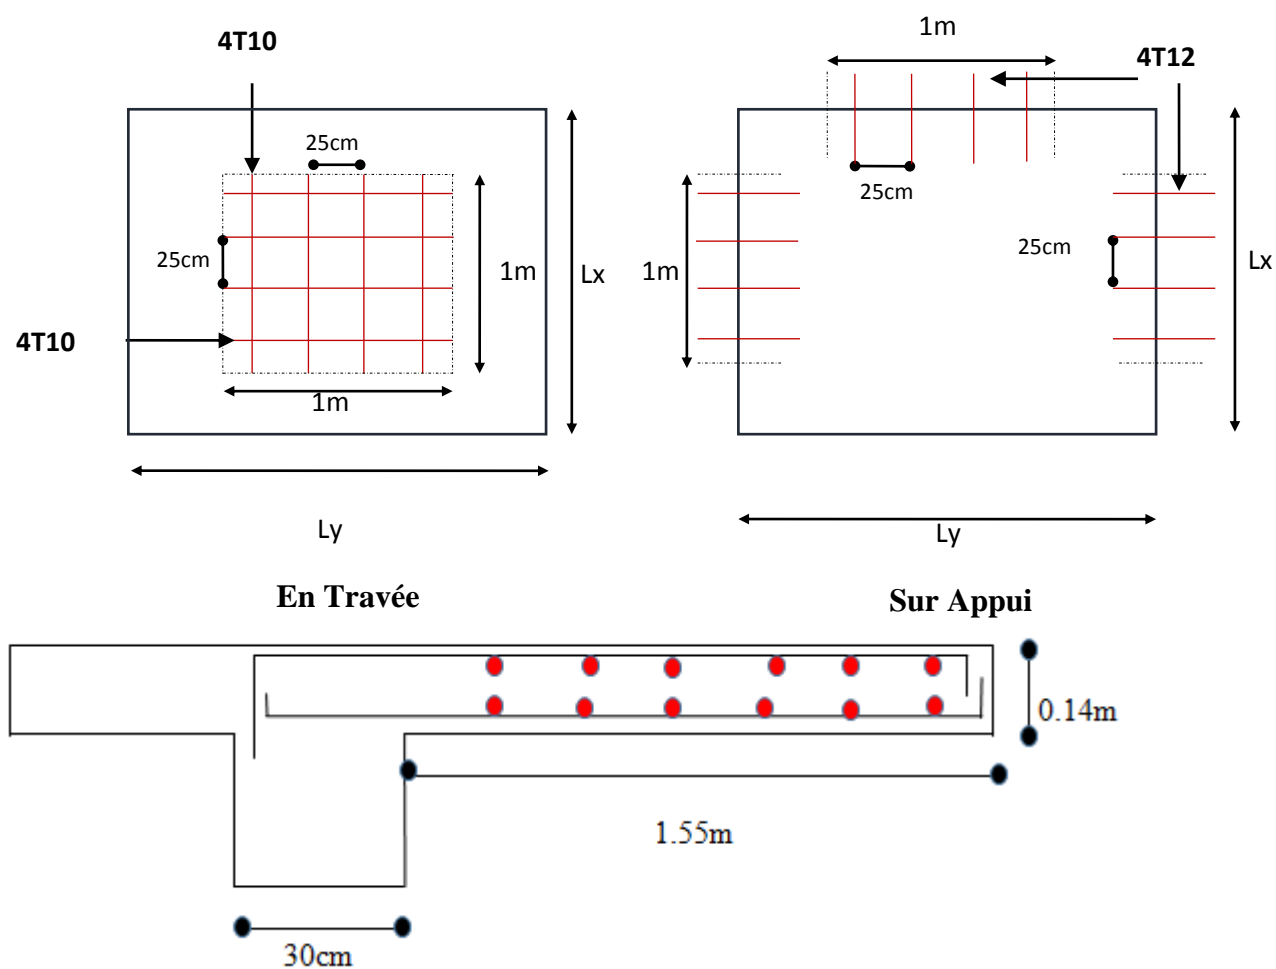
Ferrailage du balcon encastré sur deux côtés.
